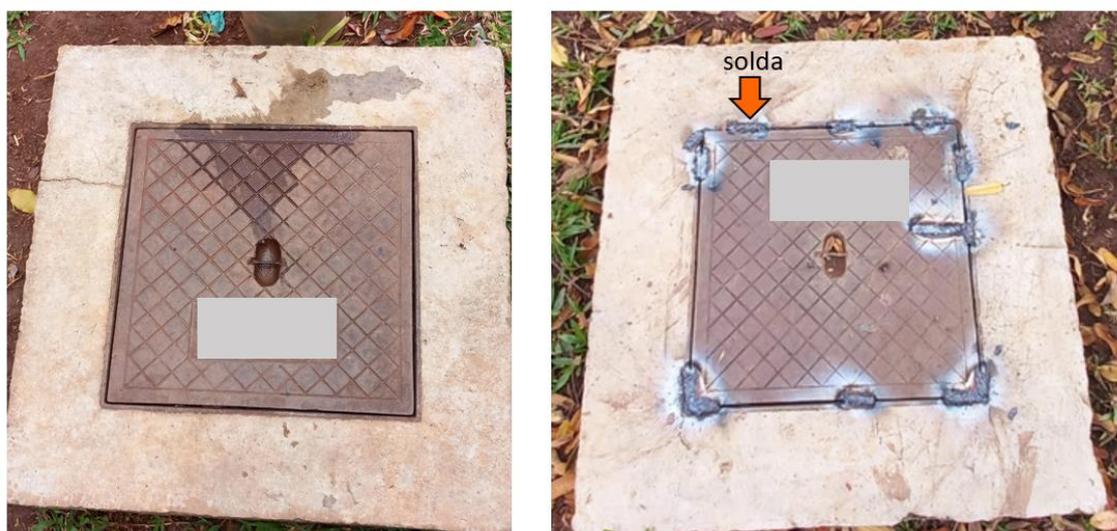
Imagem da soldagem da tampa da caixa de passagem
